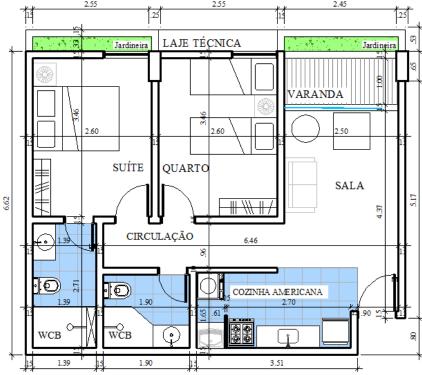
Planta Baixa de UHC de Tipologia 2 (1º ao 6º pavimento tipo)
